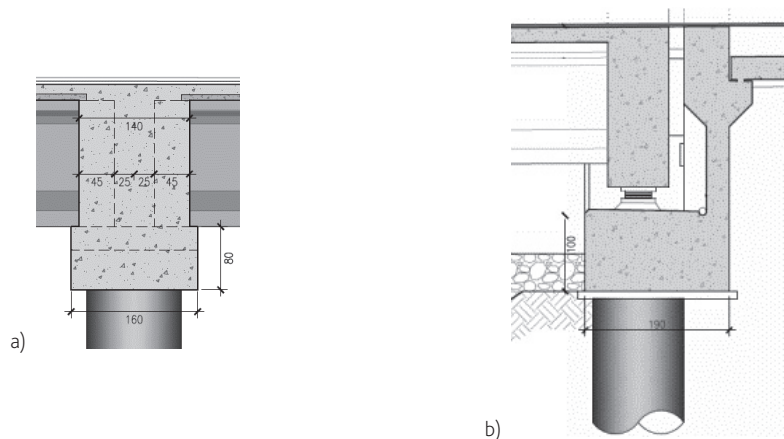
a) Secção transversal da carlinga que liga monoliticamente o tabuleiro e os pilares [5]; b) Aparelhos de neoprene e teflon e viga de apoio dos encontros que funciona como maciço de encabeçamento para as estacas [5]
